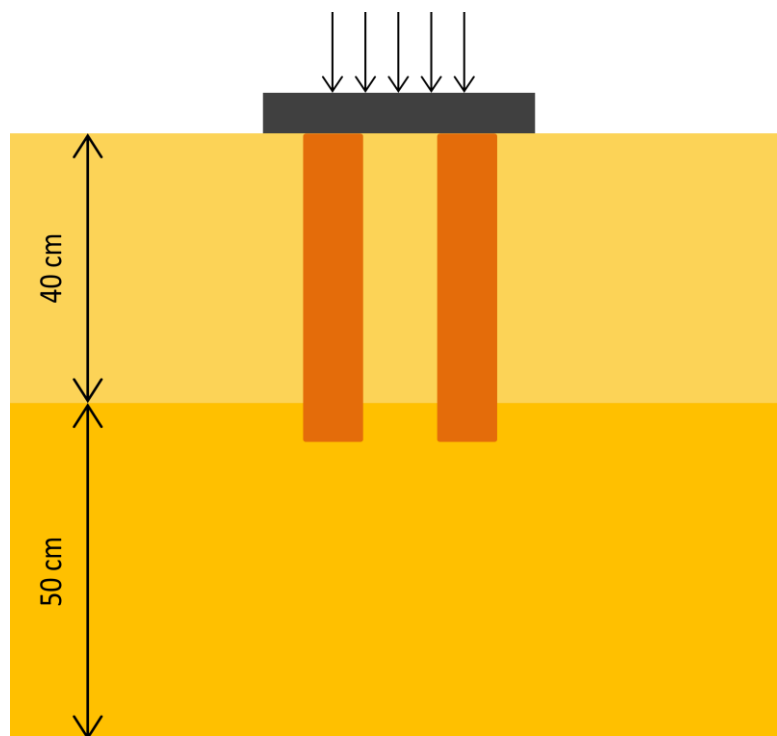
Modèle de renforcement de la semelle carrée renforcée par 4 colonnes – Pointes encastrées dans un horizon porteur (5cm)
